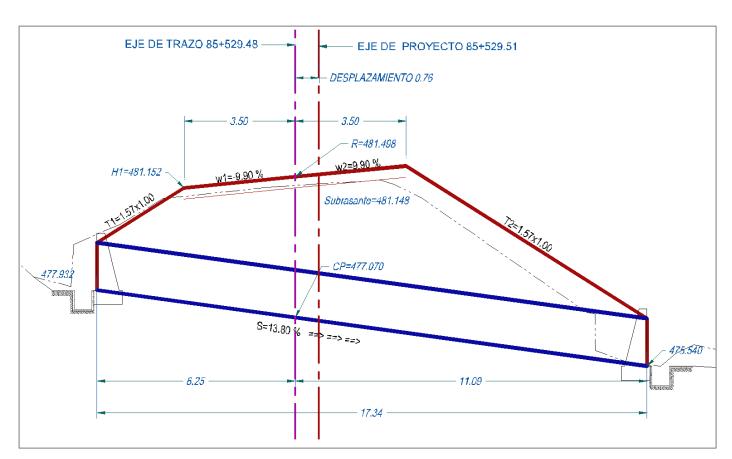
Sección de construcción, obra de drenaje 85+529.51. Ilustración, 2018.
